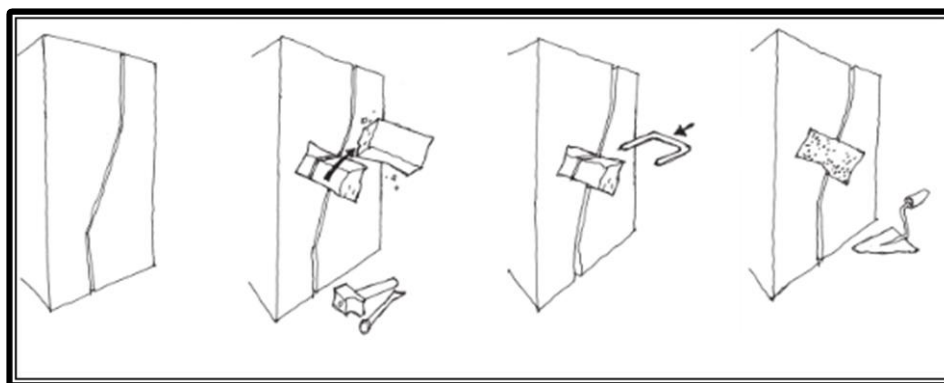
Reforzado de Muro: Técnica Cosido de Grietas.
